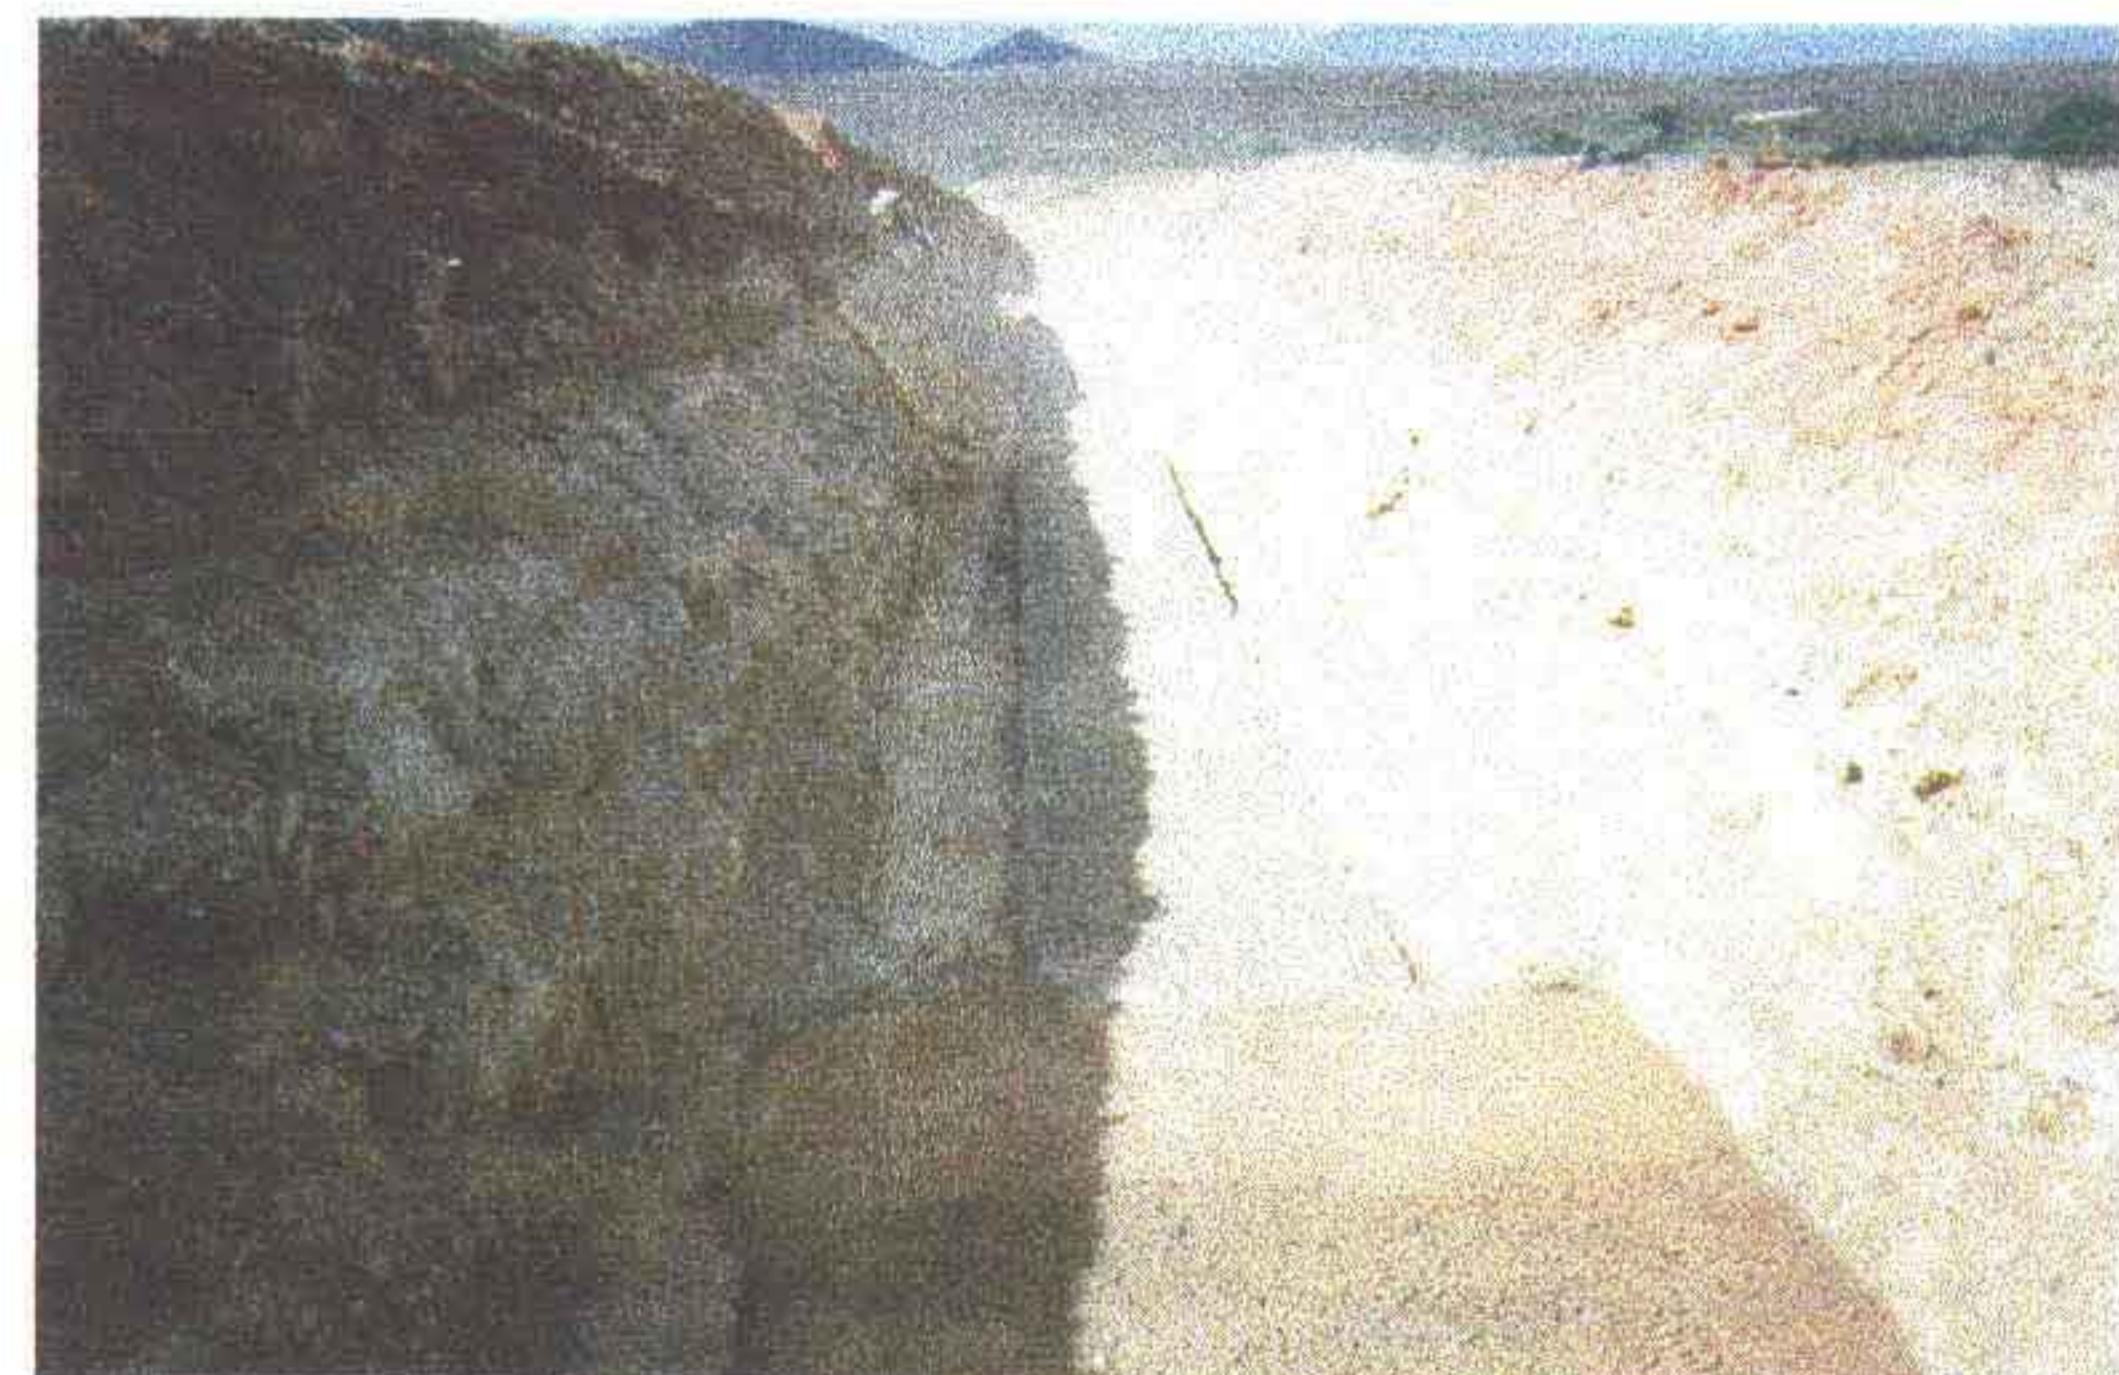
Vista da fundação da galeria. Camada de regularização já executada. Na parte inferior da foto nota-se o alargamento para base da torre.
